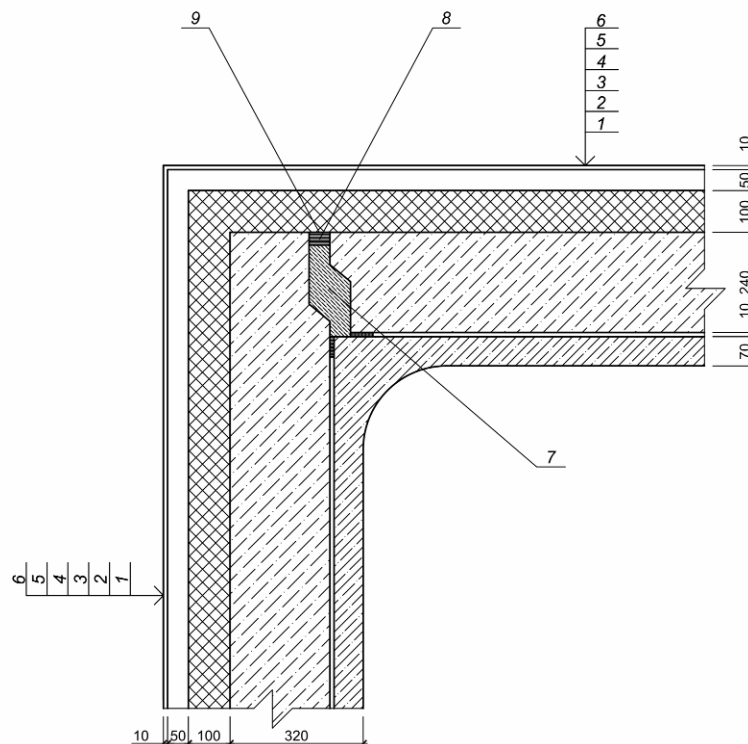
Схема проектного решения угла наружных стен (крепление облицовки фасада условно не показано): 1 — наружная облицовка; 2 — вентилируемая воздушная прослойка; 3 — утеплитель из минераловатных плит; 4 — навесная панель из керамзитобетона; 5 — монтажный шов; 6 — железобетонная конструкция объемного блока; 7 — заделка межпанельного шва керамзитобетоном; 8 — мастика строительная; 9 — защитное покрытие
